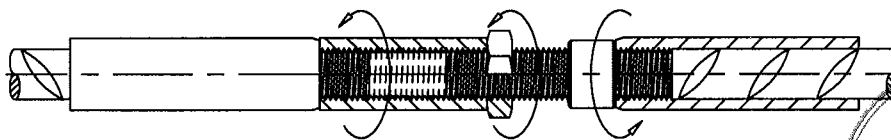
DISTANZÜBERBRÜCKENDE POSITIONSVERBINDUNG (PII) (Alternativ)
